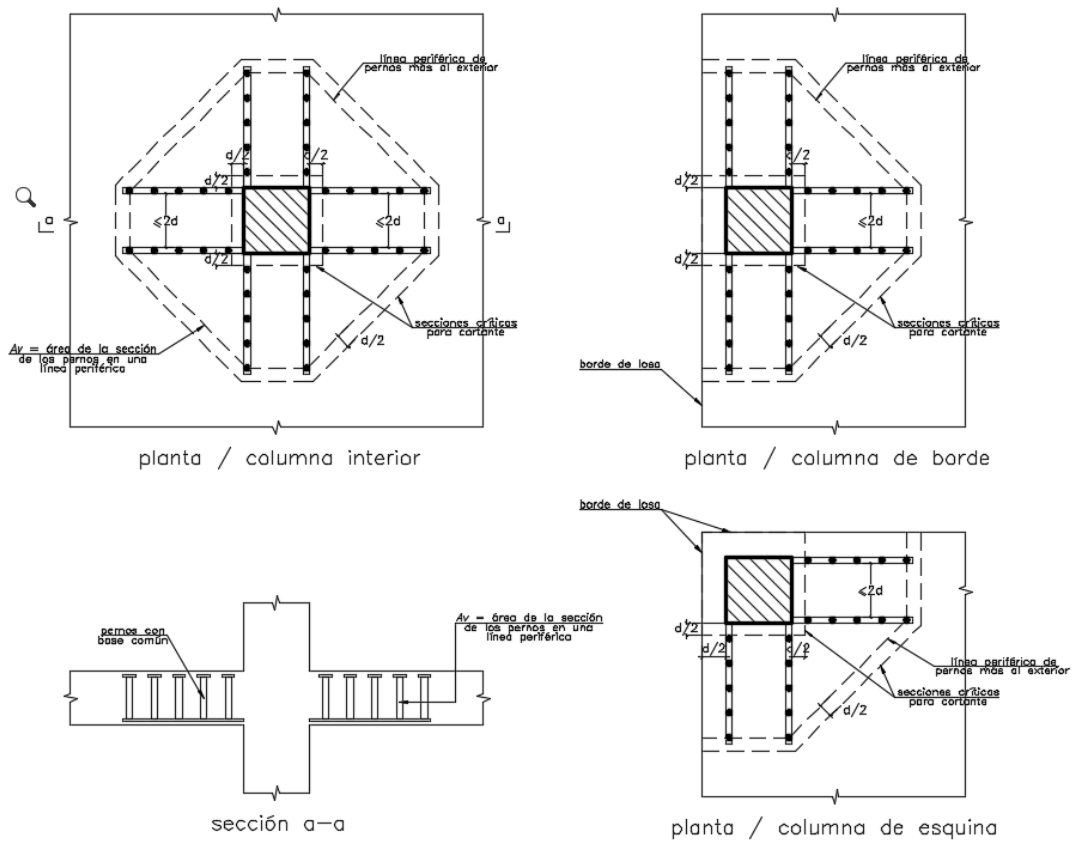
Secciones críticas y disposiciones típicas de los pernos con cabeza para refuerzo por cortante
